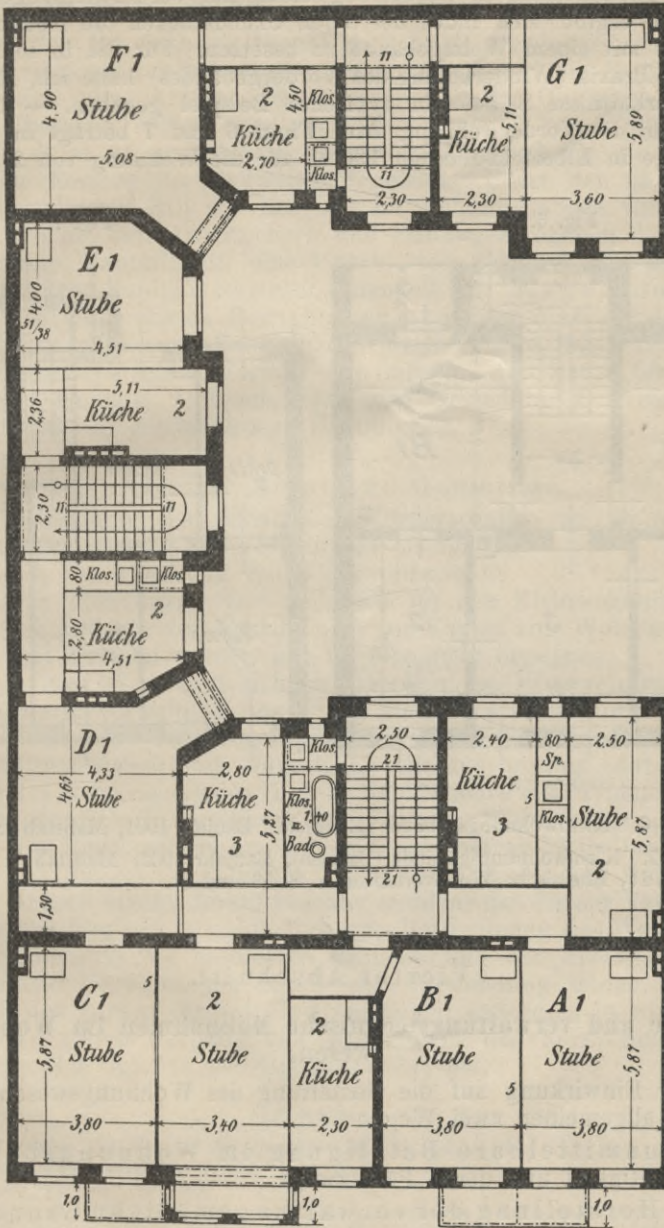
Berliner Mietskasernen mit einfachem Quergebäude. Baujahr 1904. Maßstab 1:200.
